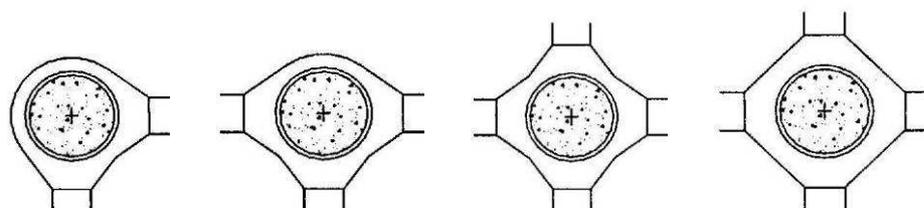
Поперечные сечения сталежелезобетонных конструкций колонн со стальными трубами каркаса здания: а – угловая колонна; б – крайняя колонна; в, г – средняя колонна
